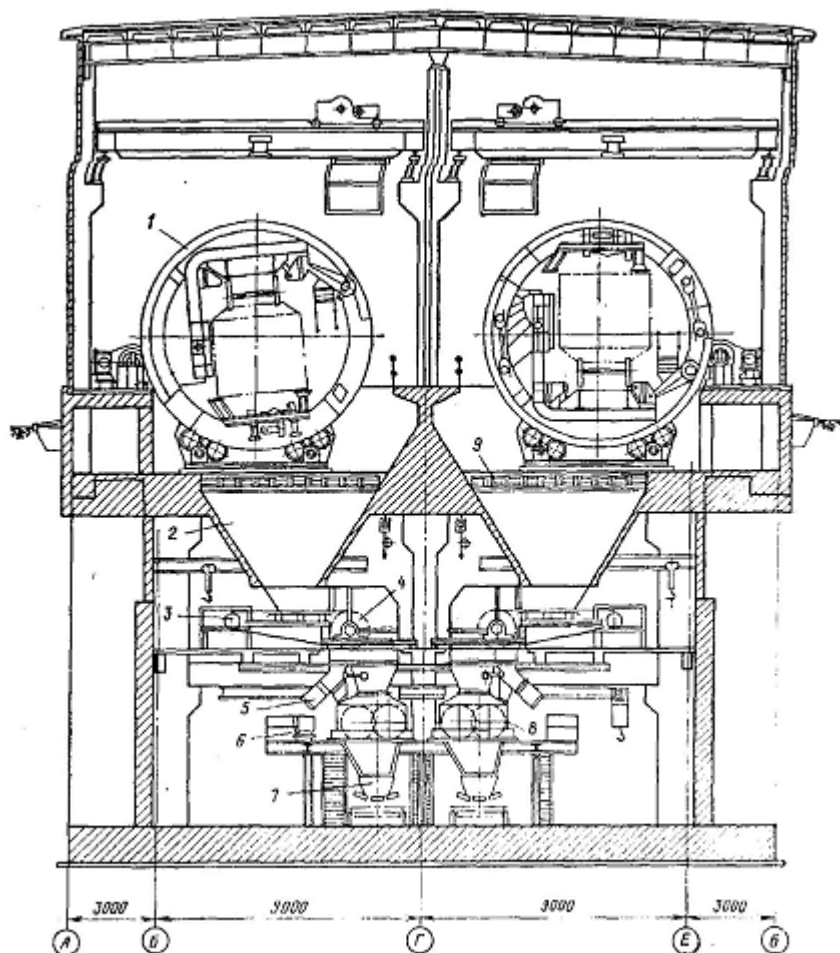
Разгрузочное устройство с двумя роторными вагонопрокидывателями [4]
